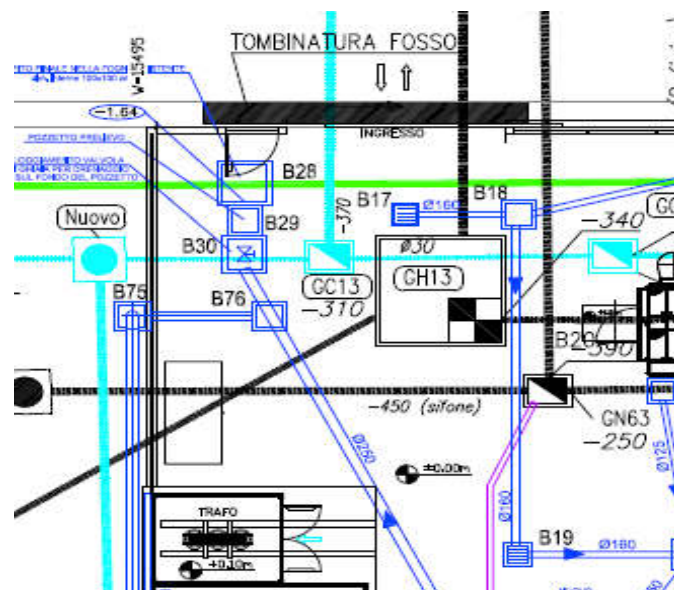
/11 Stralcio Planimetria Reti Interrate del nuovo impianto di cogenerazione - particolare della vasca raccolta acque meteoriche (M16)
